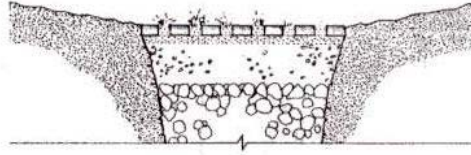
a: Alternativas de cubiertas. Pavimento celular con capas filtrantes.
